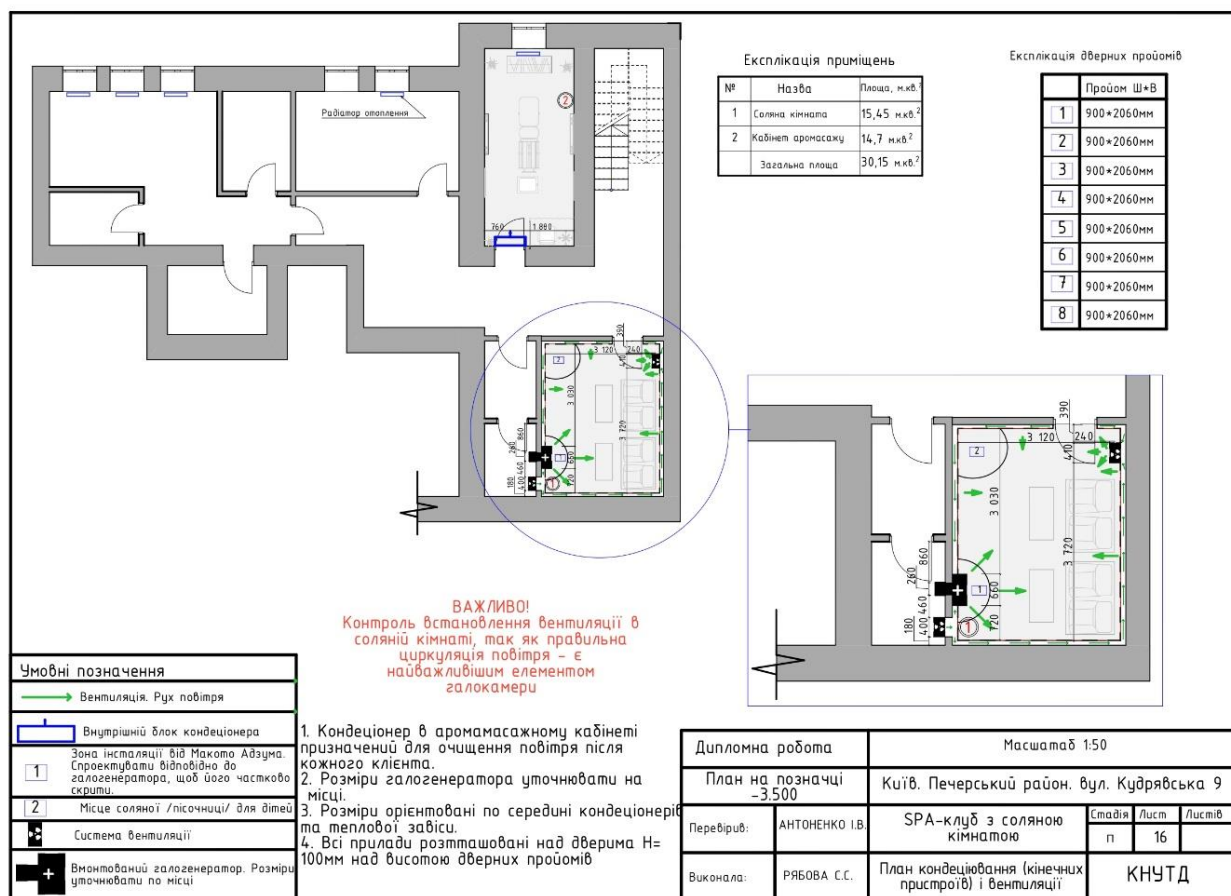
План кондиціювання та вентиляції на позначці -3.500
